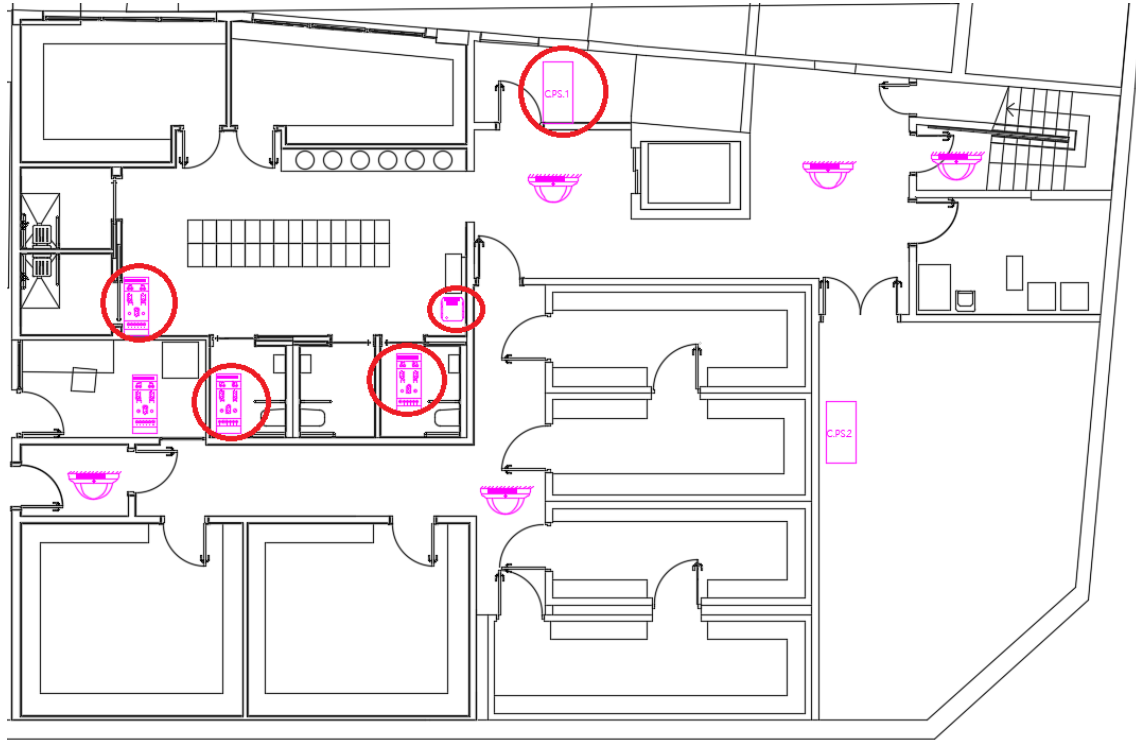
Ubicació de los dispositius instal·lats en los vestuaris de la planta sótano así como del cuadro general de la planta sótano (C.PS.1).
